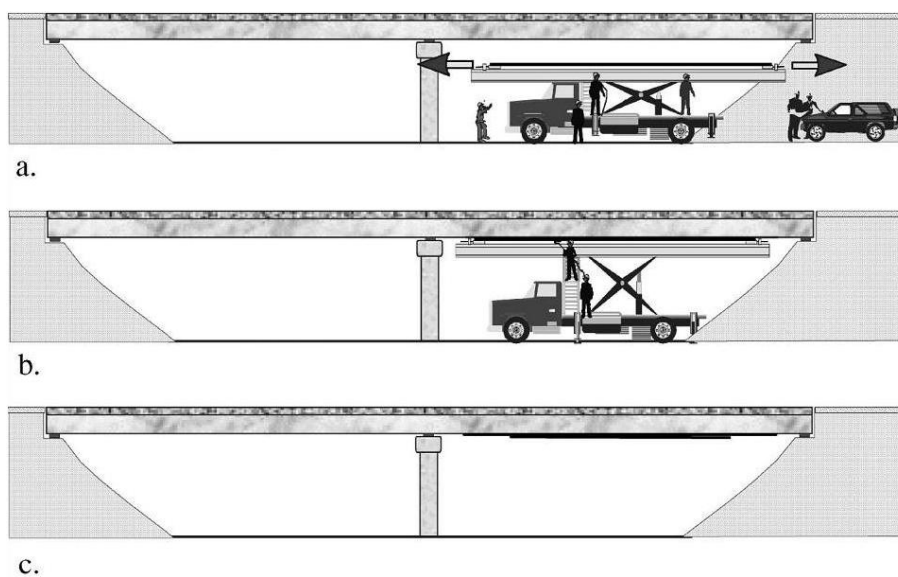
29 - Aplicação de pré-esforço ao laminado por um equipamento independente à viga. a) Amarração e tração do laminado no aparelho de pré-esforço. b) Colagem do laminado traccionado. Cura da cola epoxidica. c) Corte do laminado nas ancoragens e transferência do esforço ao composto. [23]
